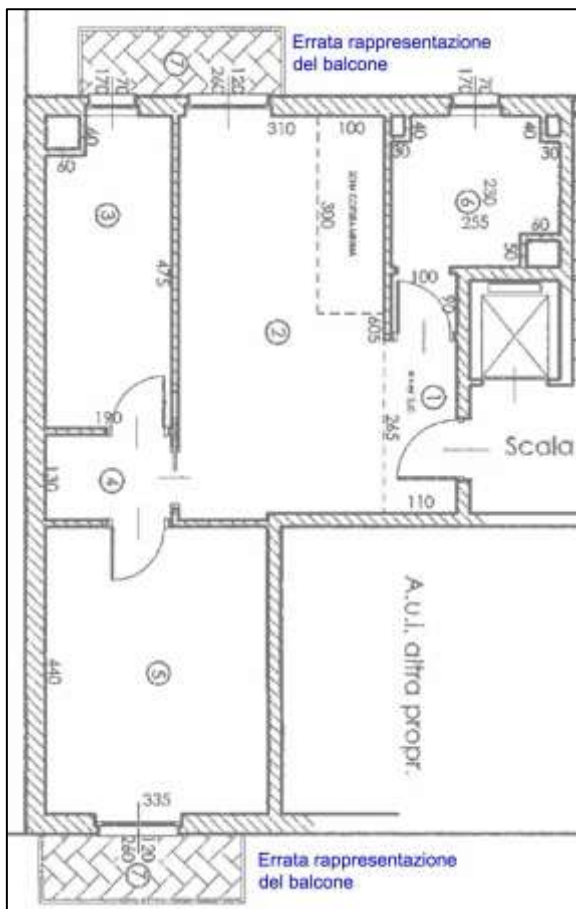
Planimetria all. a DIA del 12.05.2010
